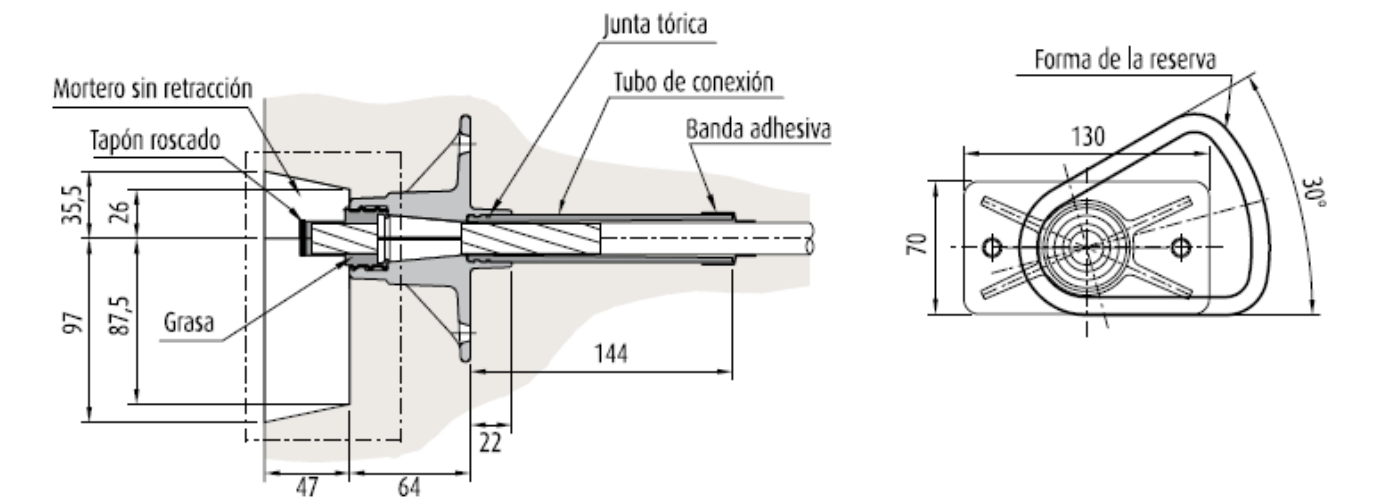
Definición geométrica y dimensiones (mm) de la unidad de anclaje tipo monocordón 1F13 de Freyssinet
